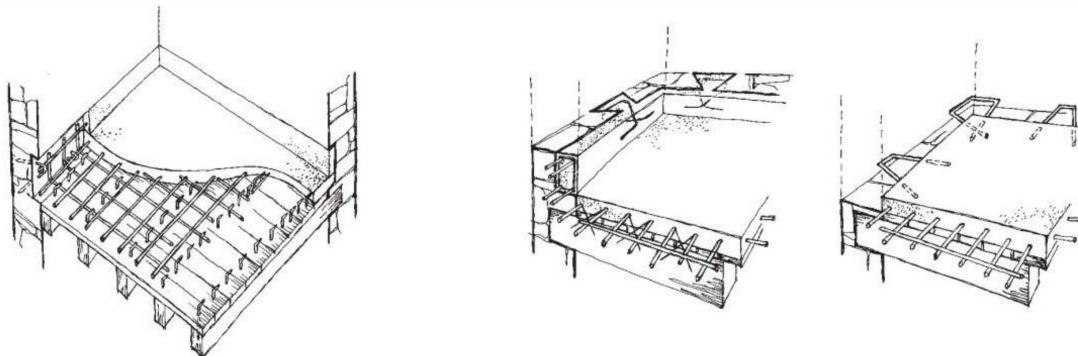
Consolidation d'un plancher par la pose d'une dalle en béton armé.
